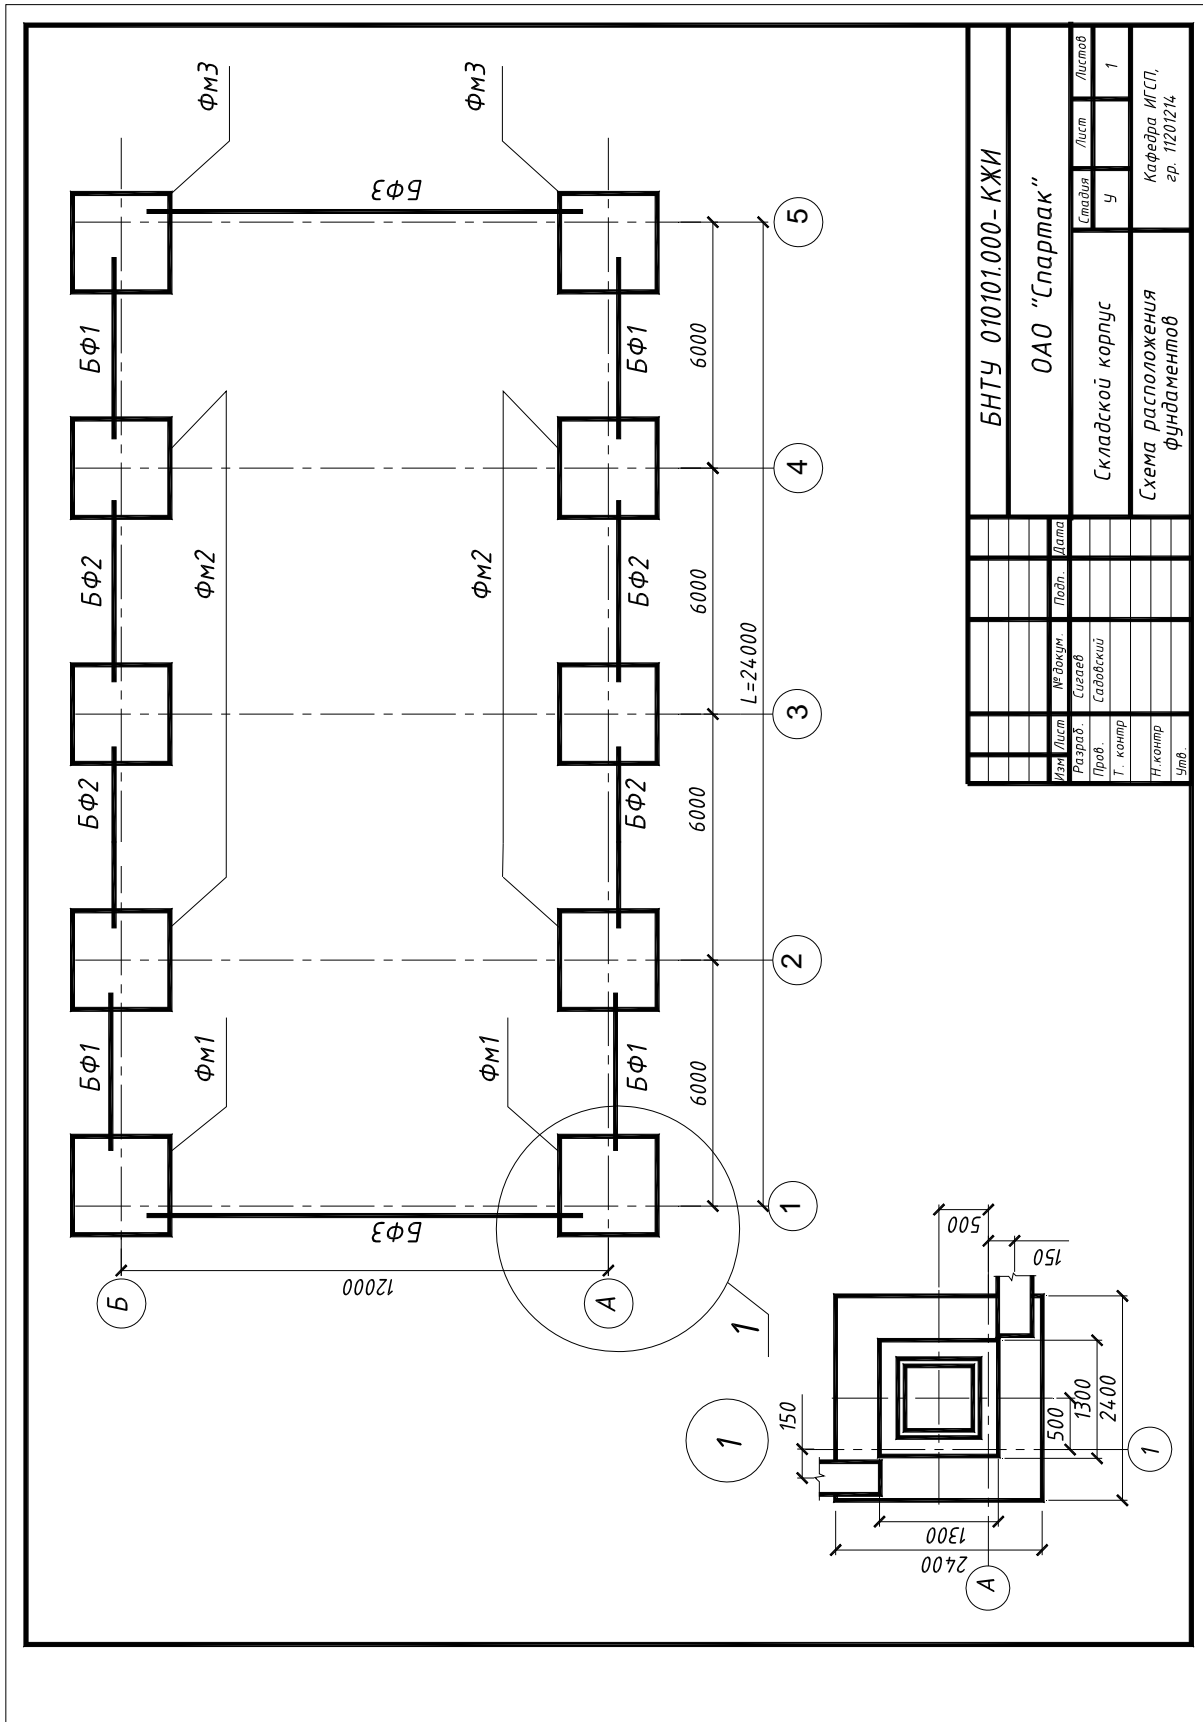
Пример выполнения схемы расположения фундаментов и фундаментных балок
